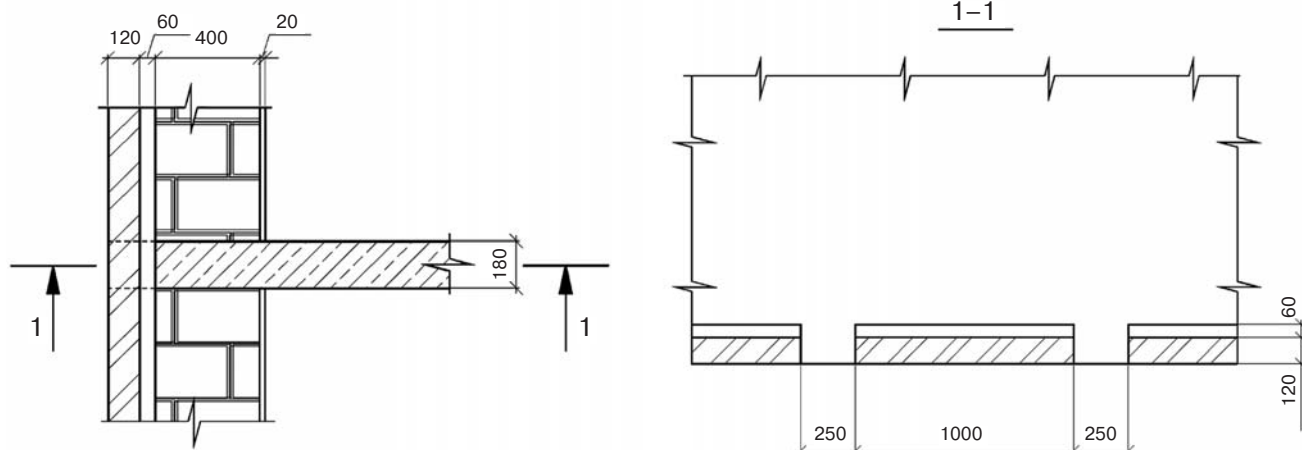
Узел сопряжения монолитного железобетонного перекрытия со стеной
